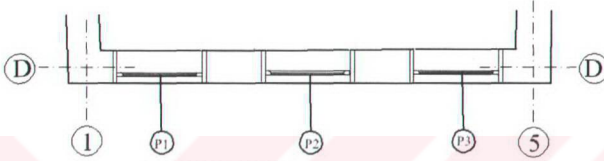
Plan çizilirken dikkat edilmesi gerekenler
